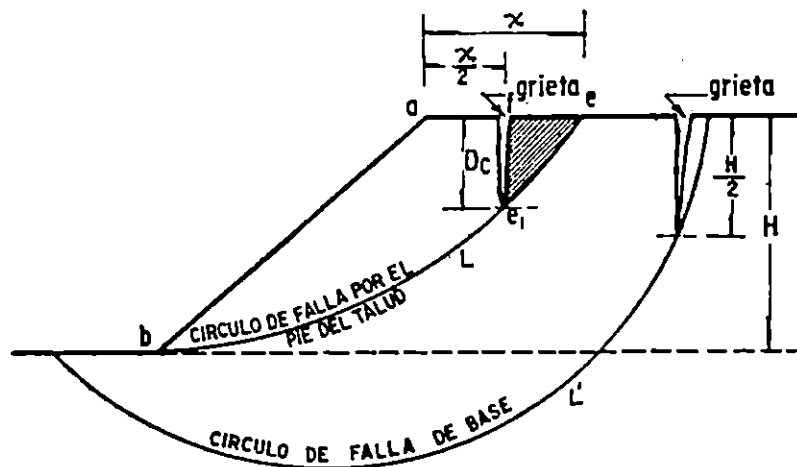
Grietas de tensión en la corona de un talud
